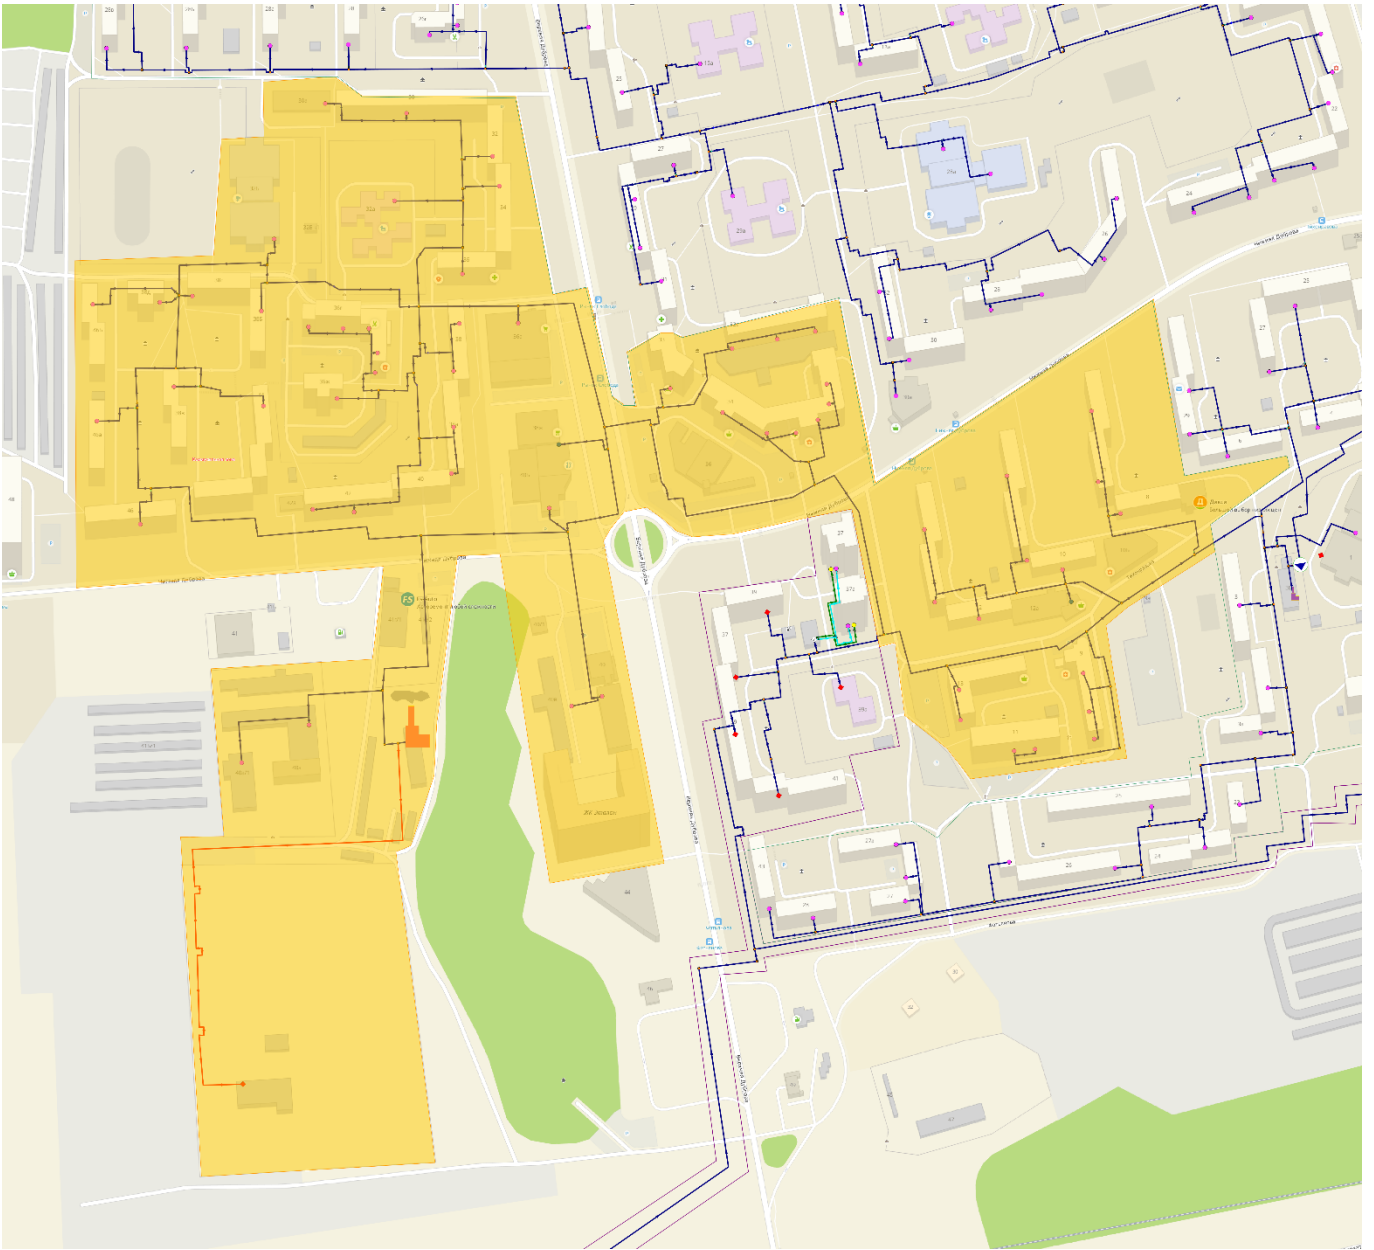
Схема тепловых сетей системы теплоснабжения котельной Коммунальная зона (ЕТО-1)
